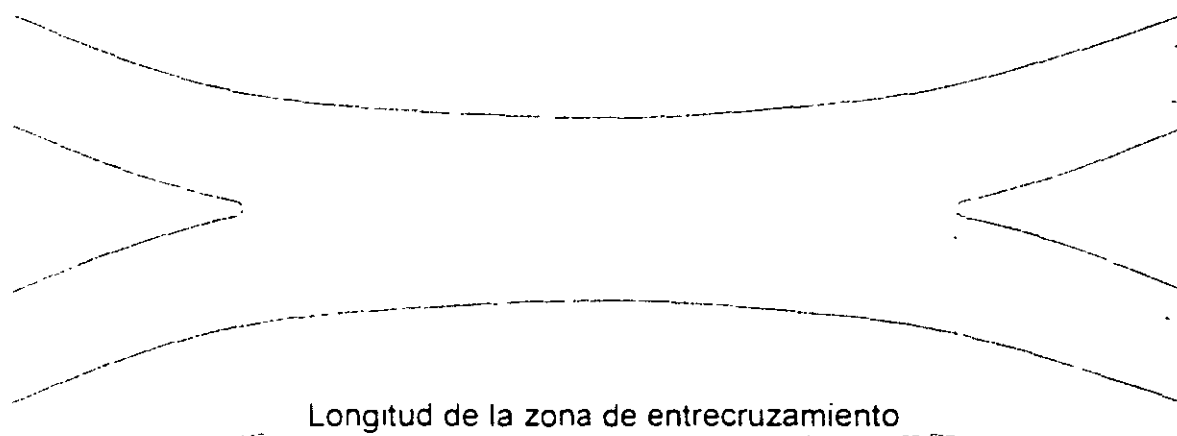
ZONA DE ENTRECruzAMIENTO COMPUESTO
